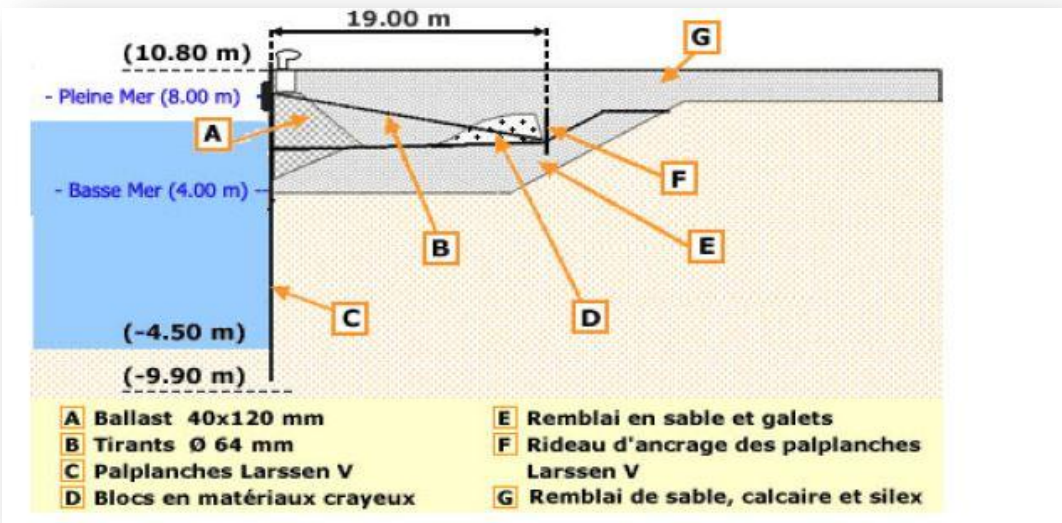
Quai en rideau de plan de palplanches métalliques
